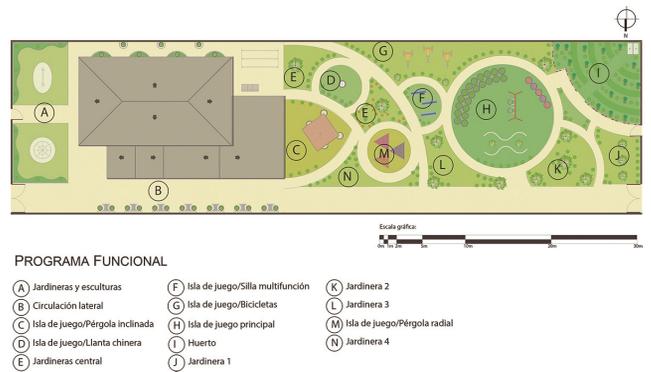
Plan Masa Proyecto Parque Infantil Sucuchina
